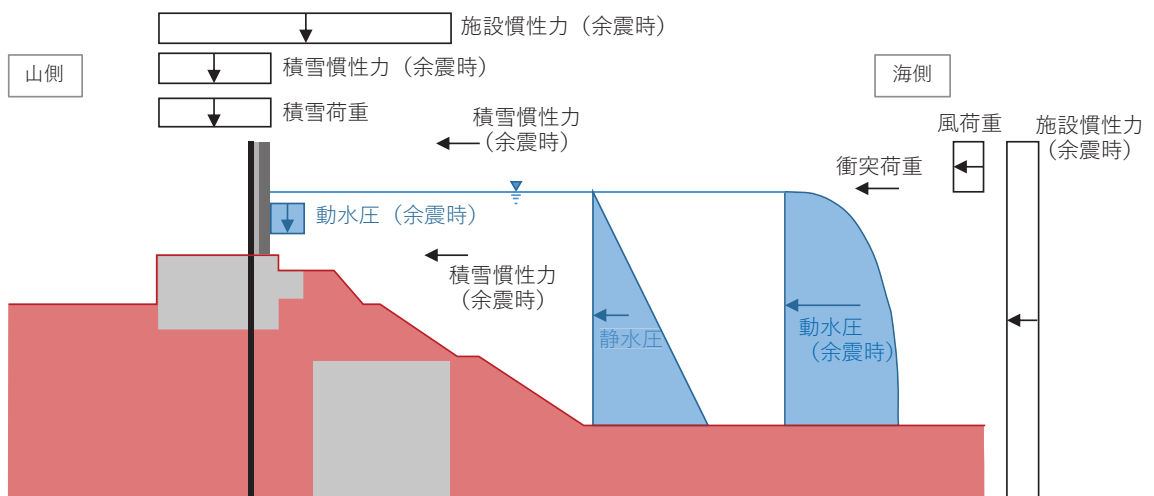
津波荷重+余震荷重+漂流物荷重による構造物に作用する水平力のイメージ図
